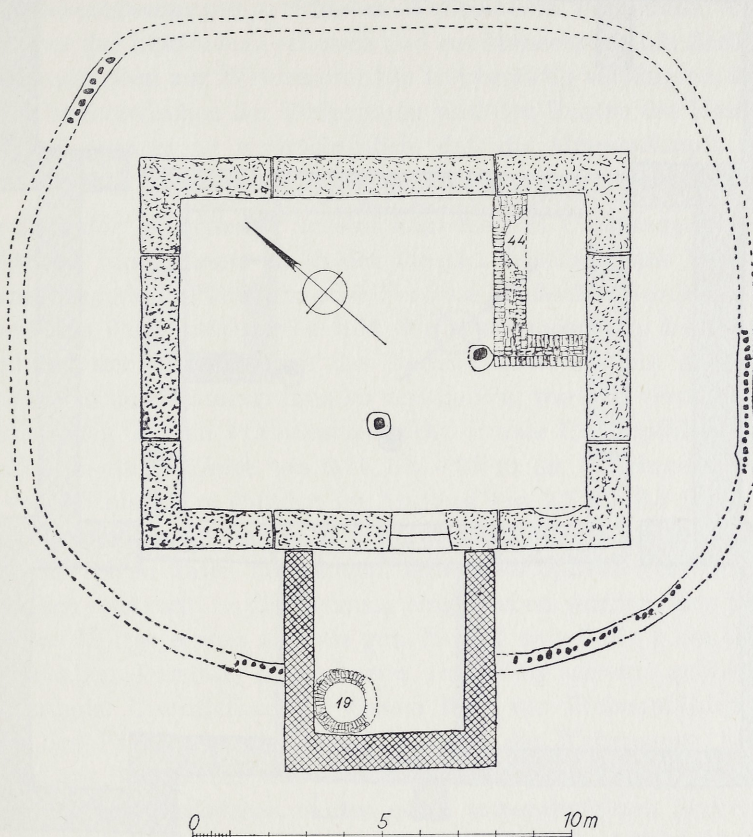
Holtrop. Grundrisse von Bau C und Torturm.
